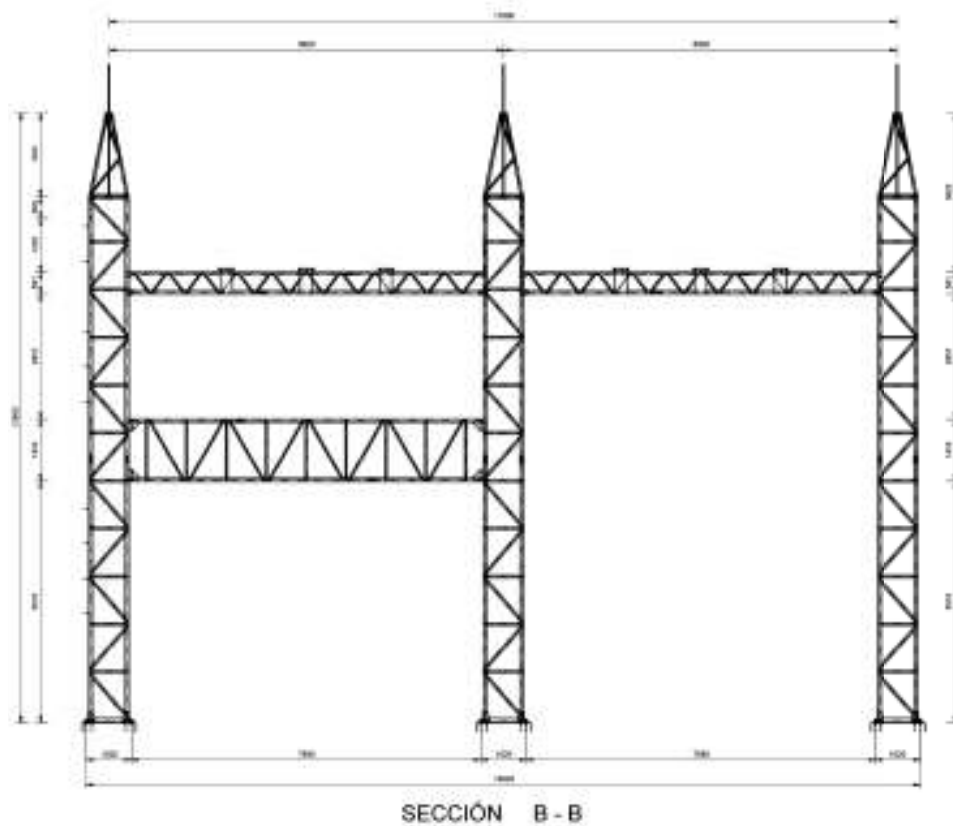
Sección B - B de la estructura metálica de la barra de 69 kV.
